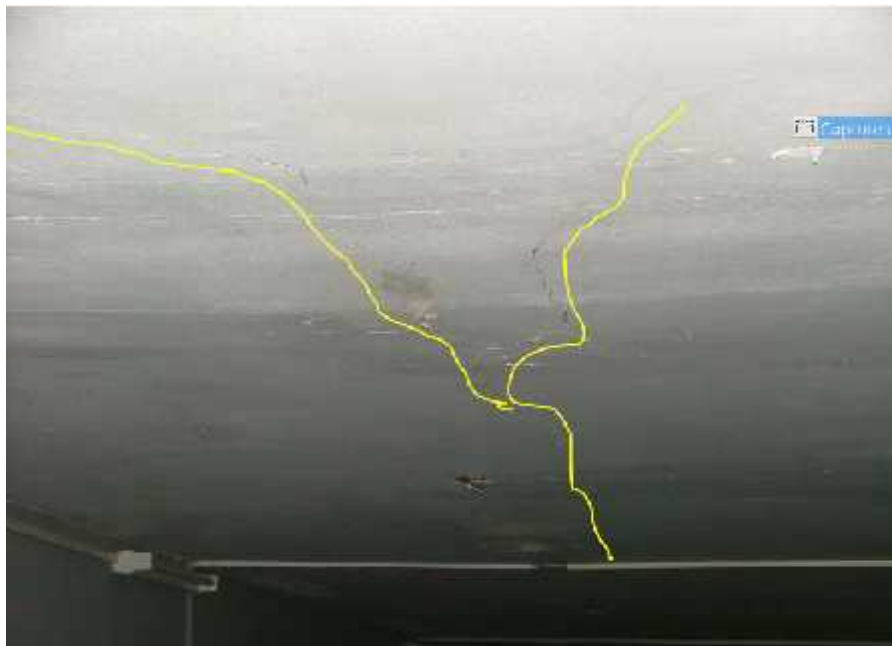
Fissuração do tecto da loja Fabiana.
